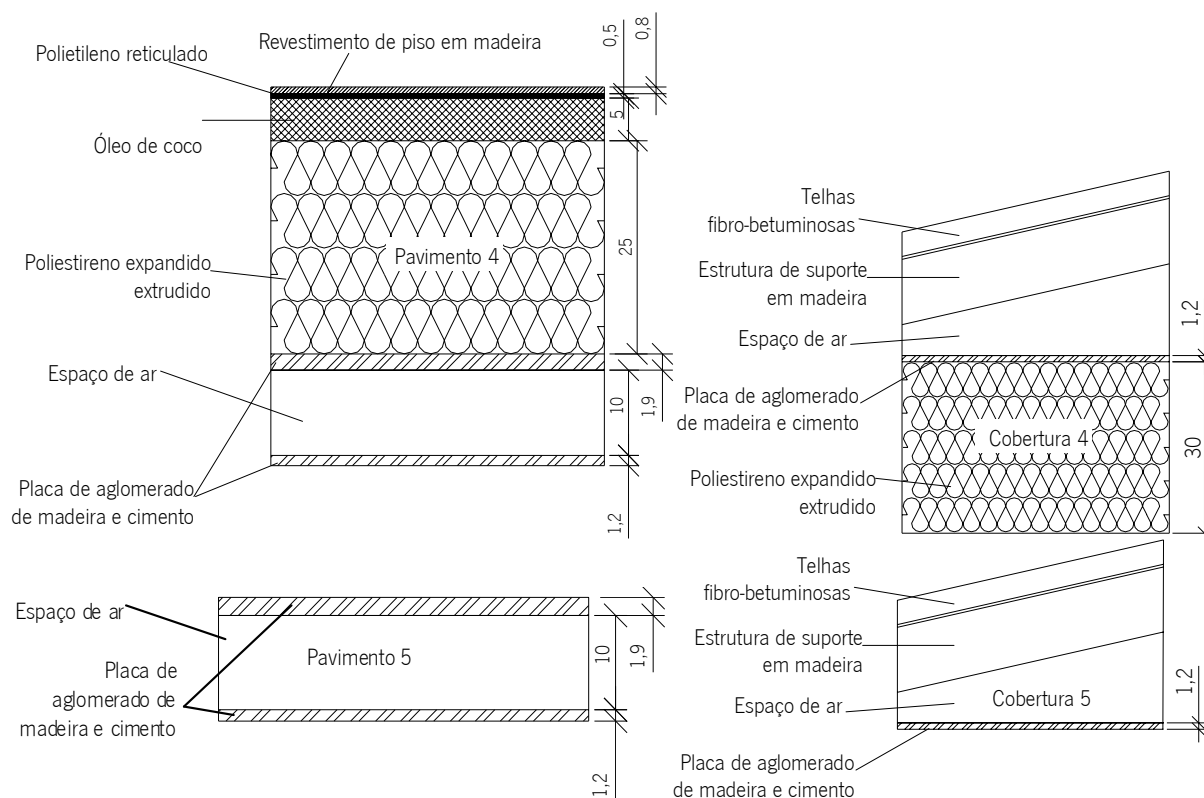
Corte esquemático das soluções construtivas da Célula Passys para as paredes, cobertura e pavimento
